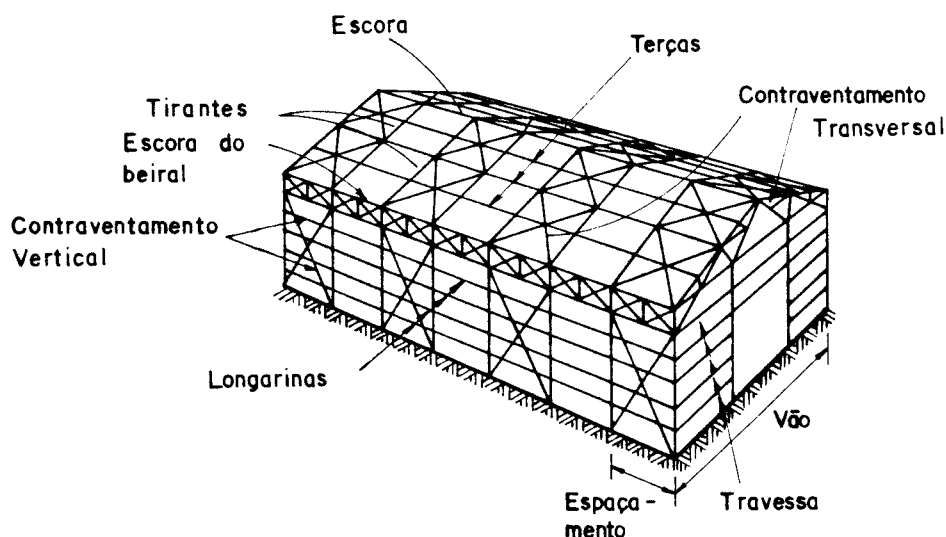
Vigamento típico de treliças em um sistema de colunas de um edifício industrial [115].
